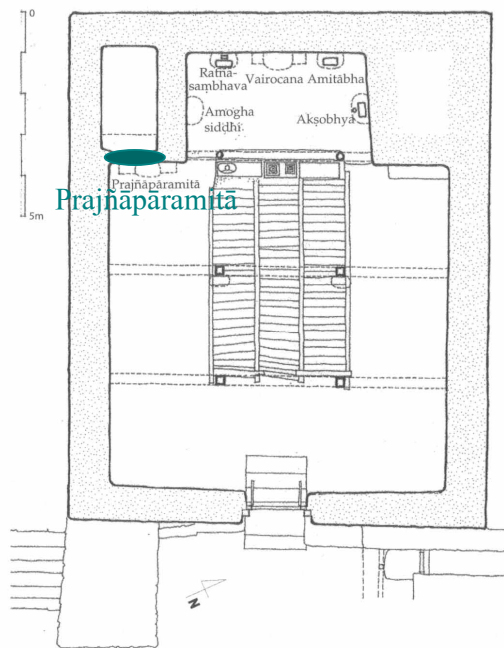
Nako, Grundriss Lo tsa ba lha khang
